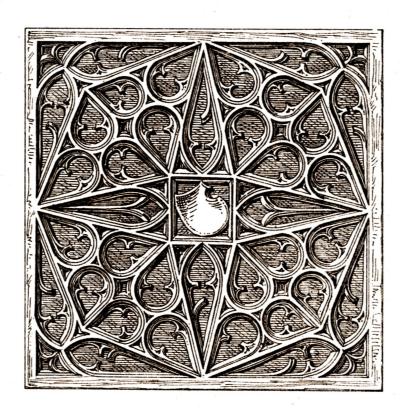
DETAILS ZUR HOLZDECKE MUF BLMTT 12.
